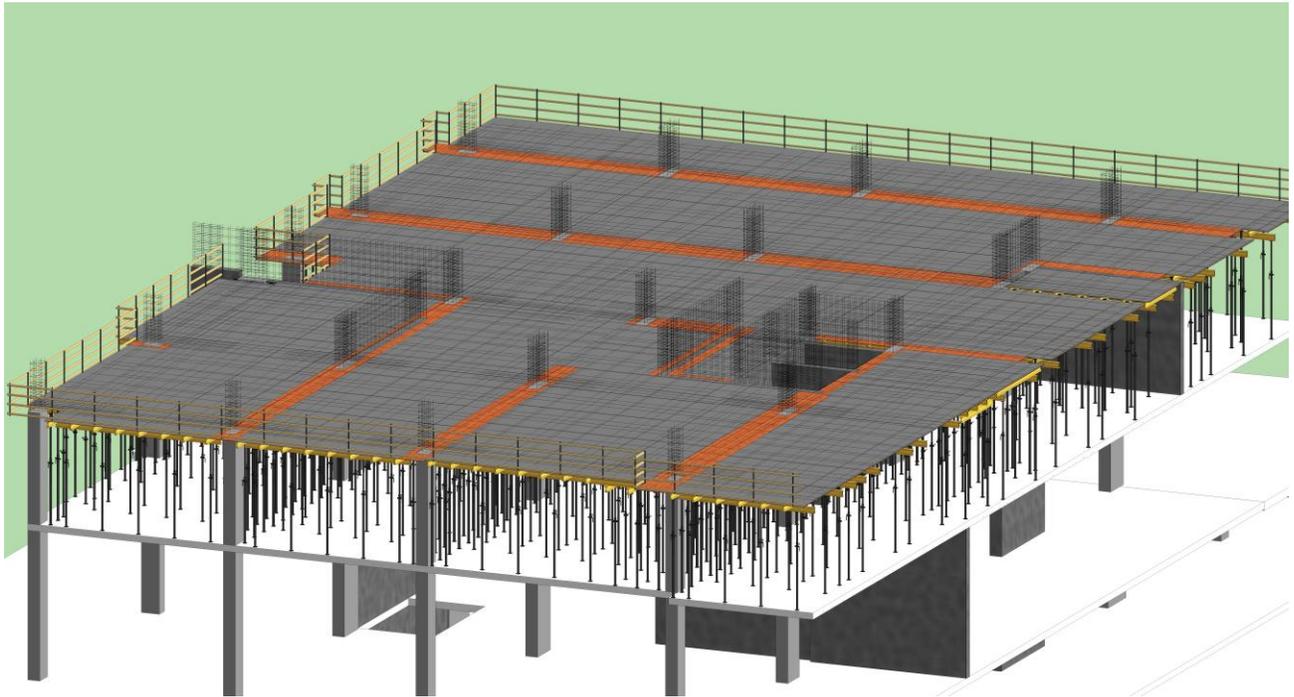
Vista 3D del encofrado para la construcción de la sección A del entepiso del nivel 2
